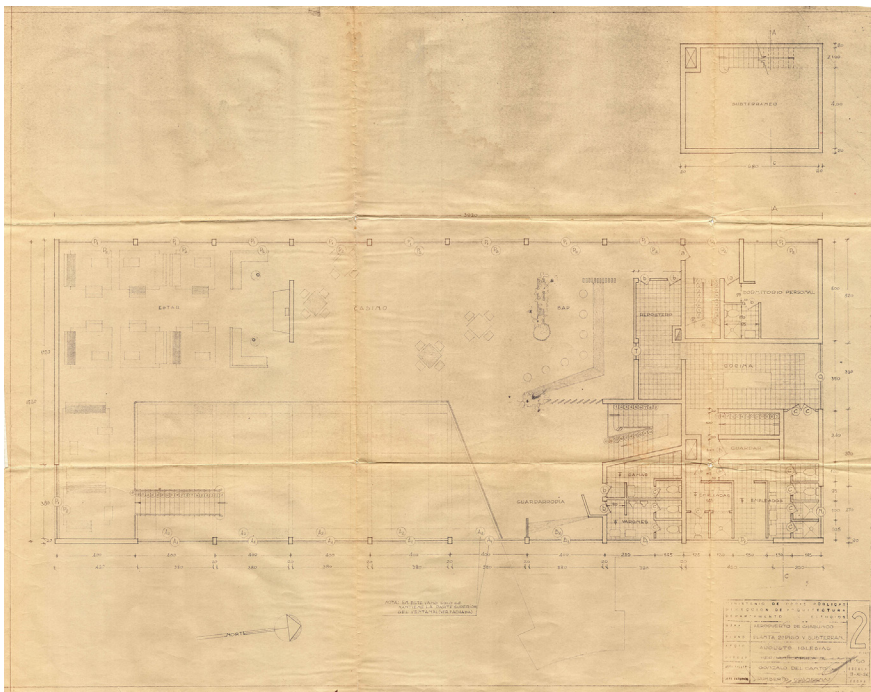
Planta 2º piso y subterráneo (fuente: Ministerio de Obras Públicas, 1956).
